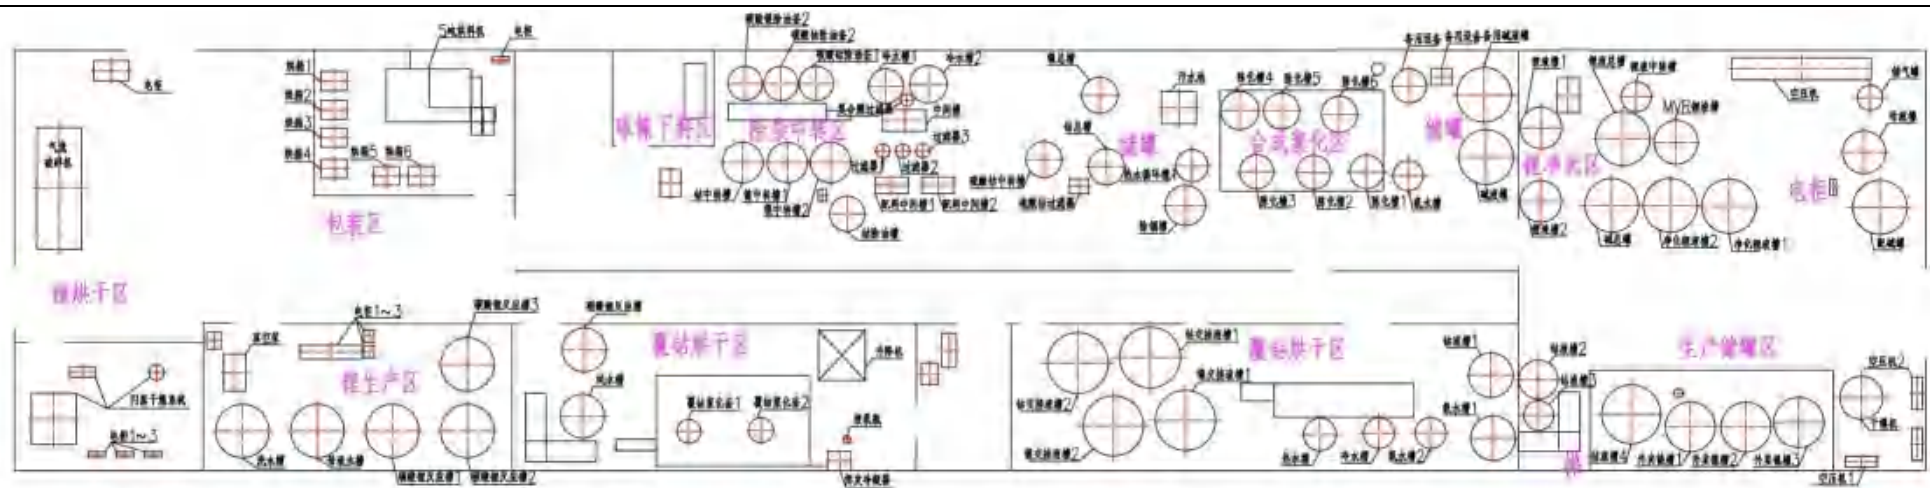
合成车间设备设施平面布置图 (1 楼一层)
